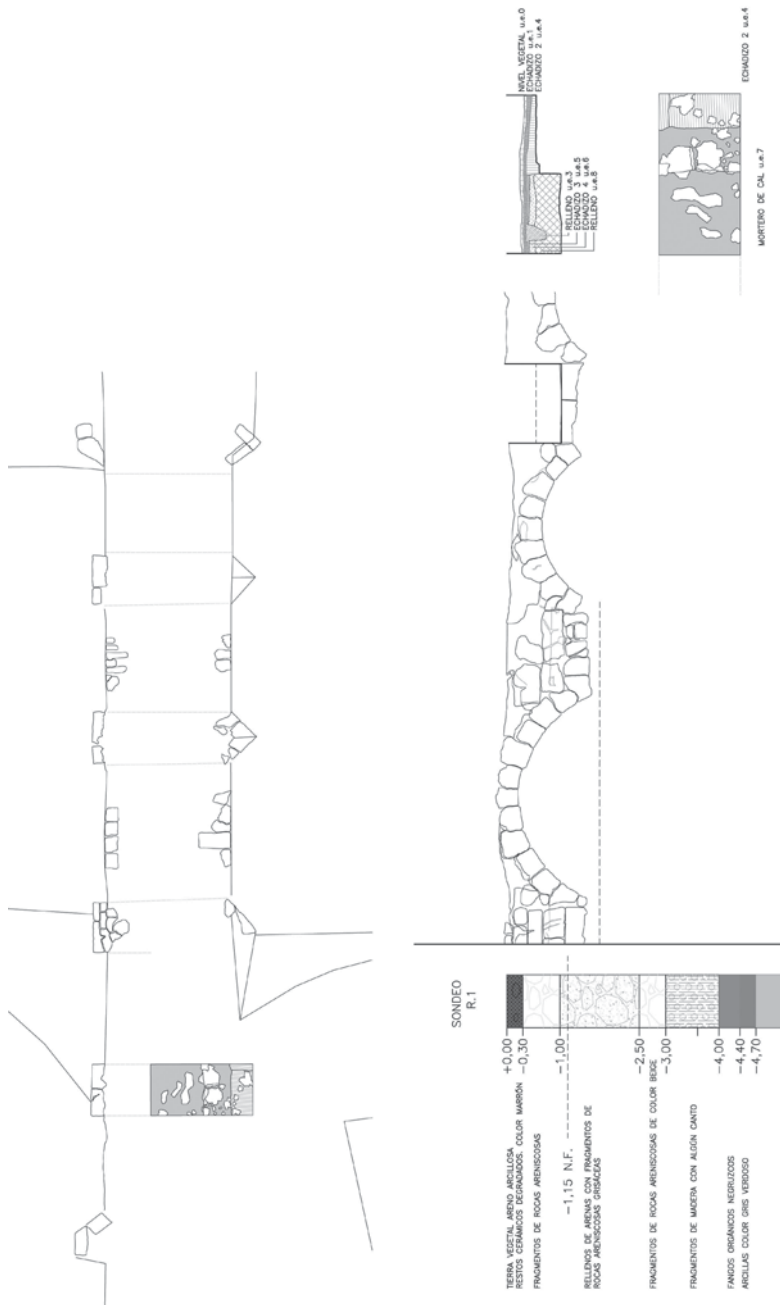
Documentación arqueológica. Proyecto de restauración. Planimetría base, Ana Viñé.
